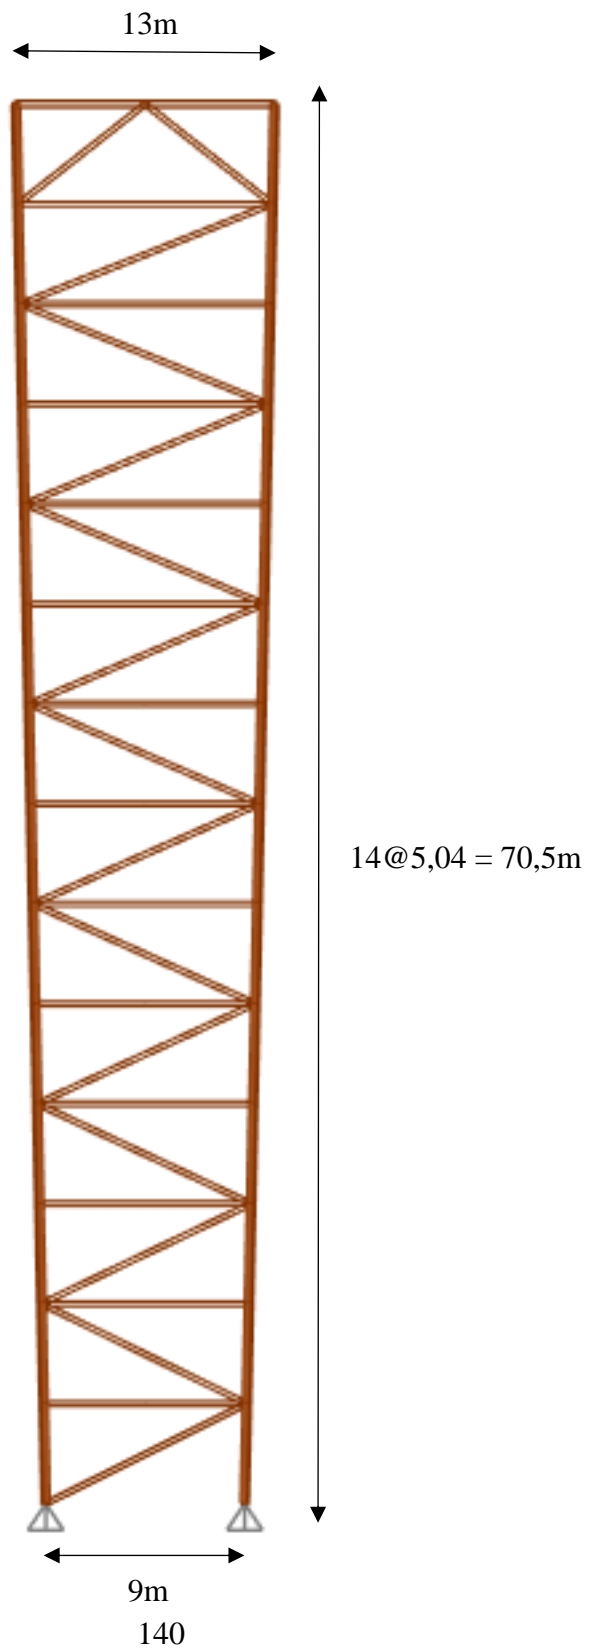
Ceba 2 y 3 sección longitudinal (externa).
